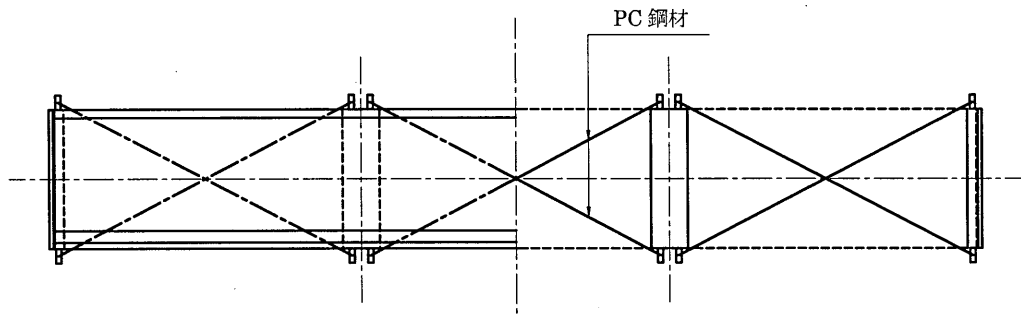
外ケーブルを利用した補強対策の実施例
